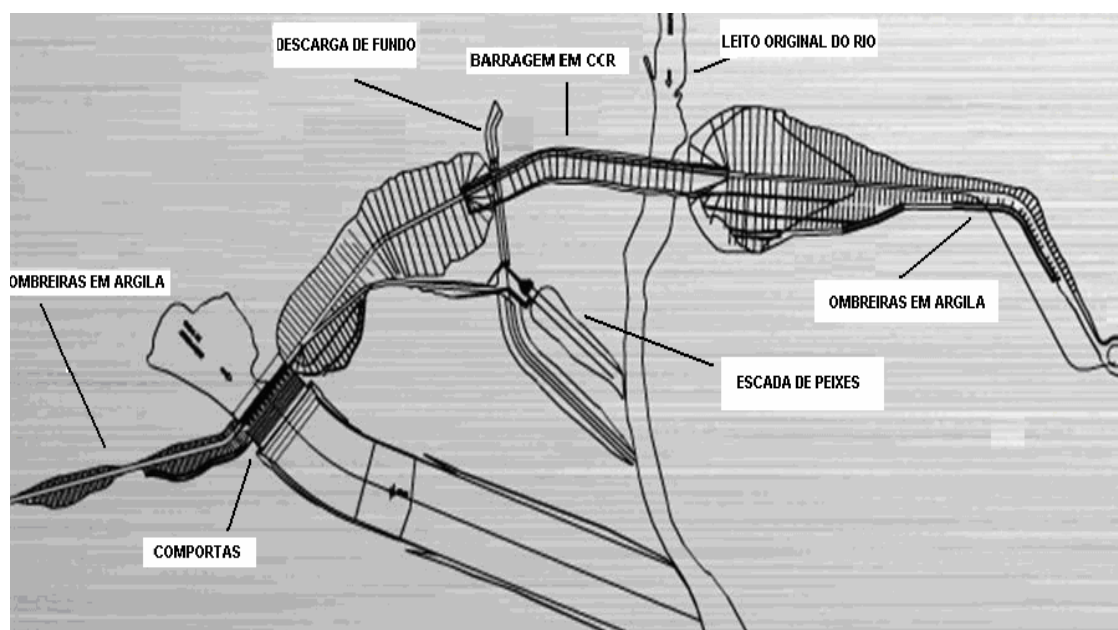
Croqui e arranjos estruturais do Açude Castanhão – CE.
